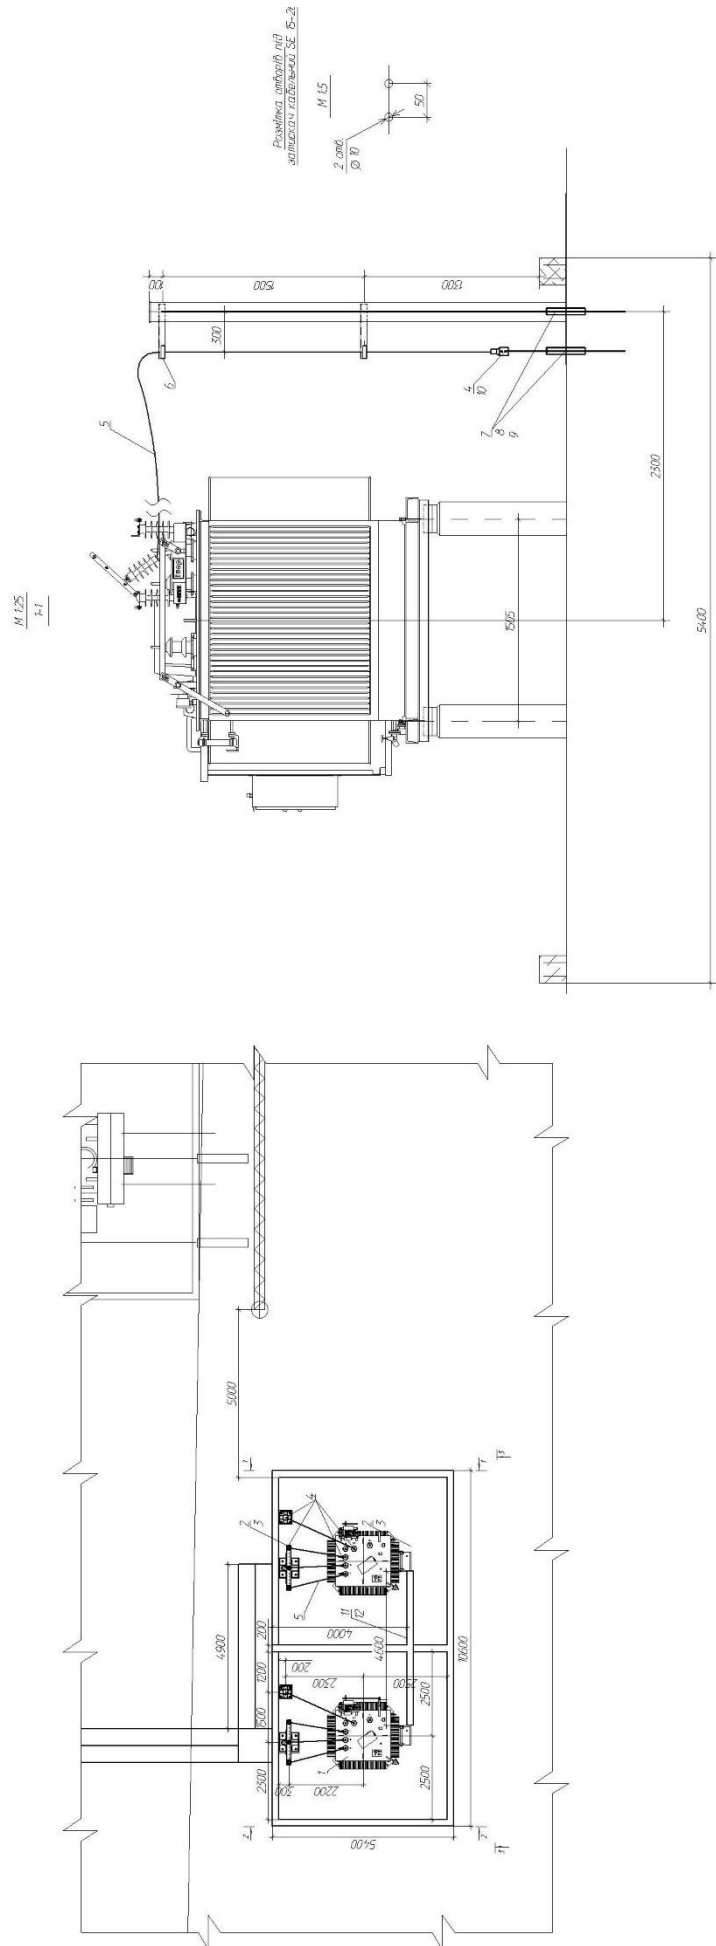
Установка ДГК ASRC2.OP. Фрагмент плану, розріз
